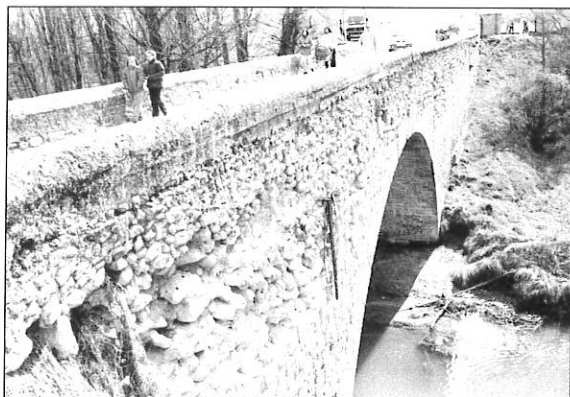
El tablero del Puente Conchuela de Aranda se rectificó con rasante horizontal a base de muretes de mampostería, muy dañados en la actualidad.
